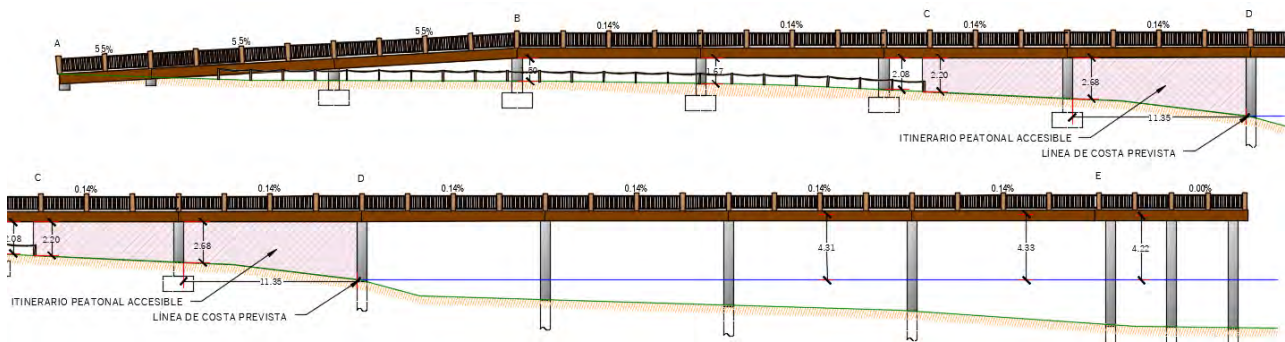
Captura del Plano 02 Perfil longitudinal Alternativa 4 (Anexo 1 Planos).
